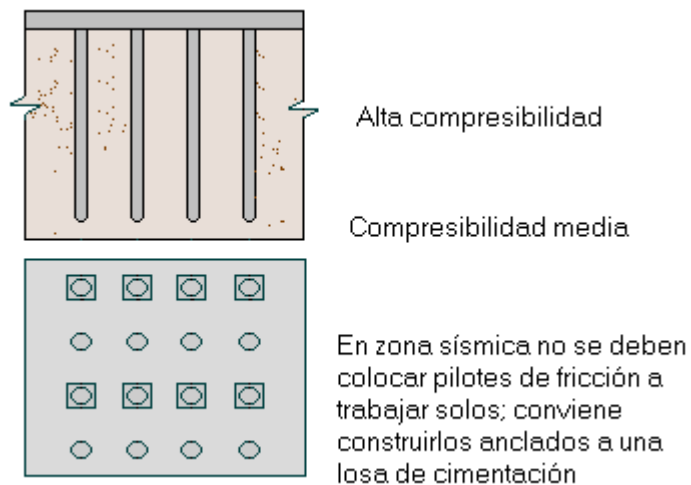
Pilotes por fricción construida monolíticamente con una losa de cimentación
